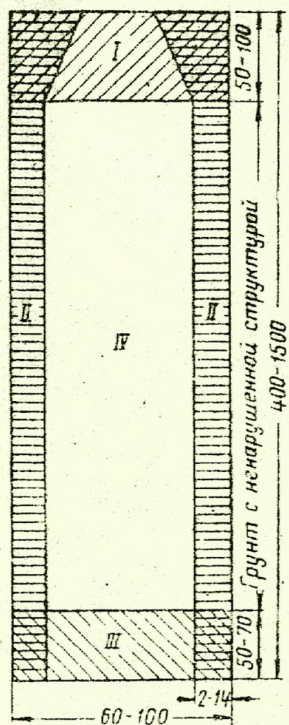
Схематический продольный разрез образца грунта отобранного грунтоносом из буровой скважины
